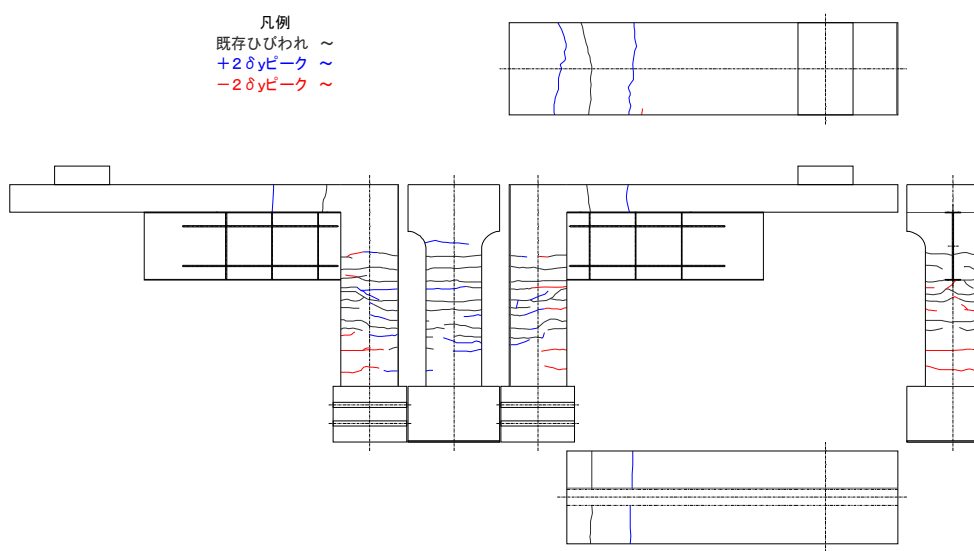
に各サイクルにおけるひび割れ損傷図を示す。また、写真 4.1.2 に実験終了後のひび割れ状況写真を示す。図 4.1.10 の A 点（降伏前載荷 5、水平変位 3.3mm）において、図 4.1.11 (a) に示すように、下フランジ下面付近に初期ひび割れが生じた。さらに、図 4.1.10 の B 点（ $3\delta_y$ 、水平変位 ± 23.4 mm）において、コンクリート断面の終局耐力に達し、その後徐々に水平剛性の低下が見られた。最終的に、過年度実験で見られた床版と橋台の接合部コンクリート及び橋台上面の上フランジ中心線に沿った橋軸方向のひび割れ、鋼桁の引抜きに伴う接合部前面コンクリートのコーン状破壊は見られず、下フランジ下面付近を中心とした橋台のひび割れの進展に終始した。
